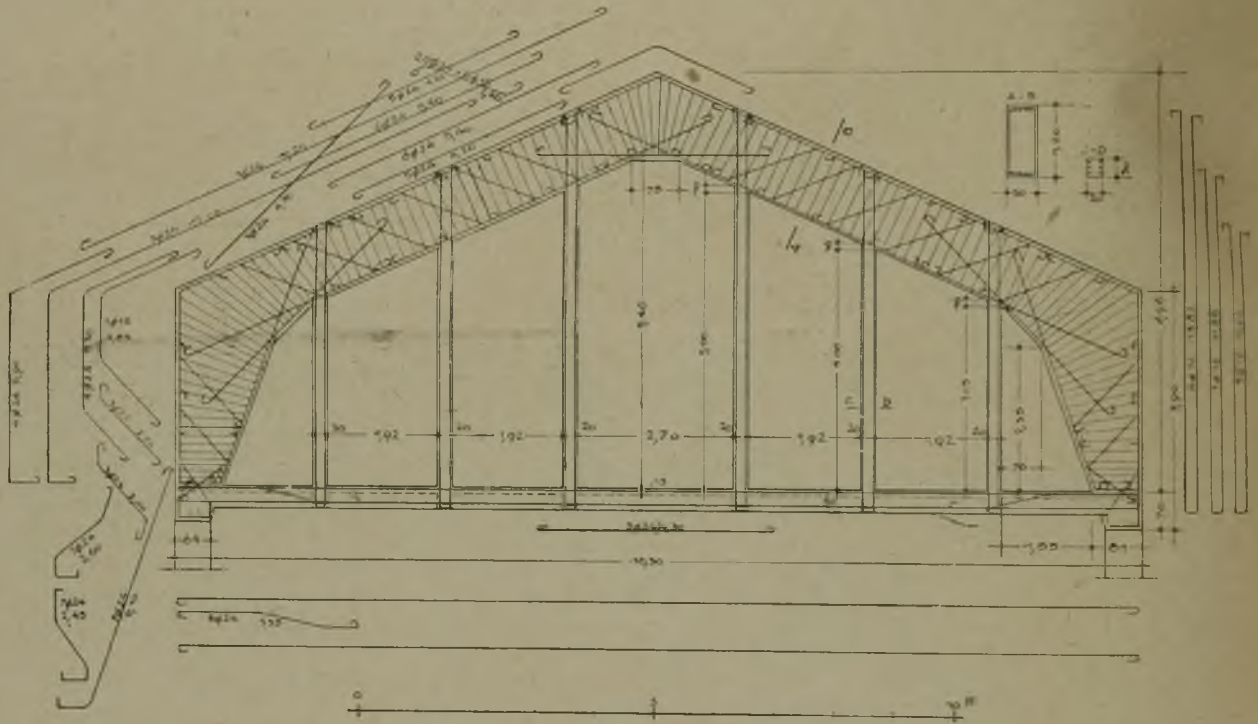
Konstruktion und Bewehrung des Dachbinders mit angehängter Decke.
